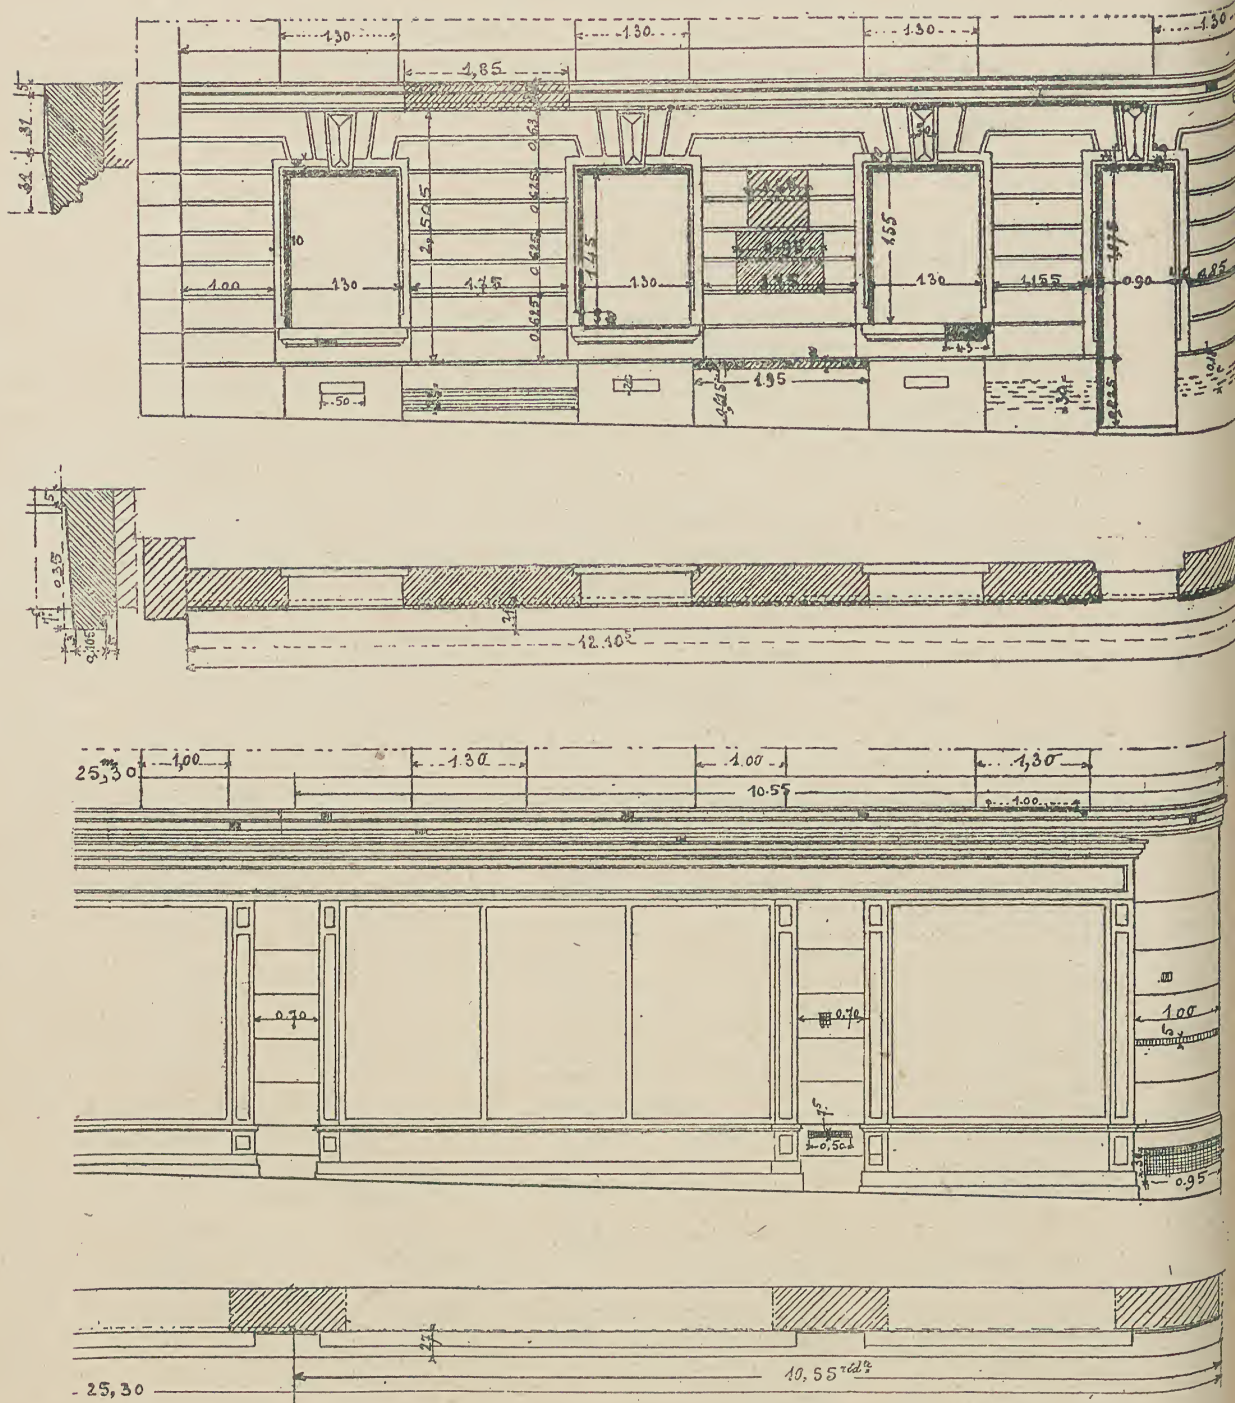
Ravalement sur pierre vicille à rez-de-chaussée.
